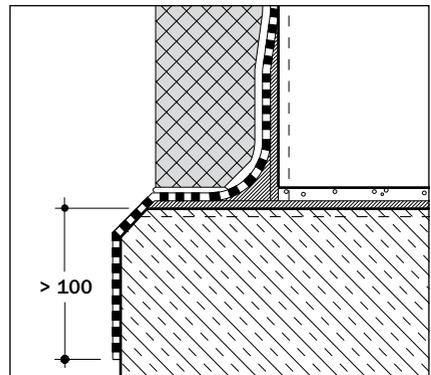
/13: Anschluss einer einkomponentigen KMB-Abdichtung am Bodenplattenab-satz, Querschnittsabdichtung und Untergrundvorbehandlung mit Dichtungsschlamme
